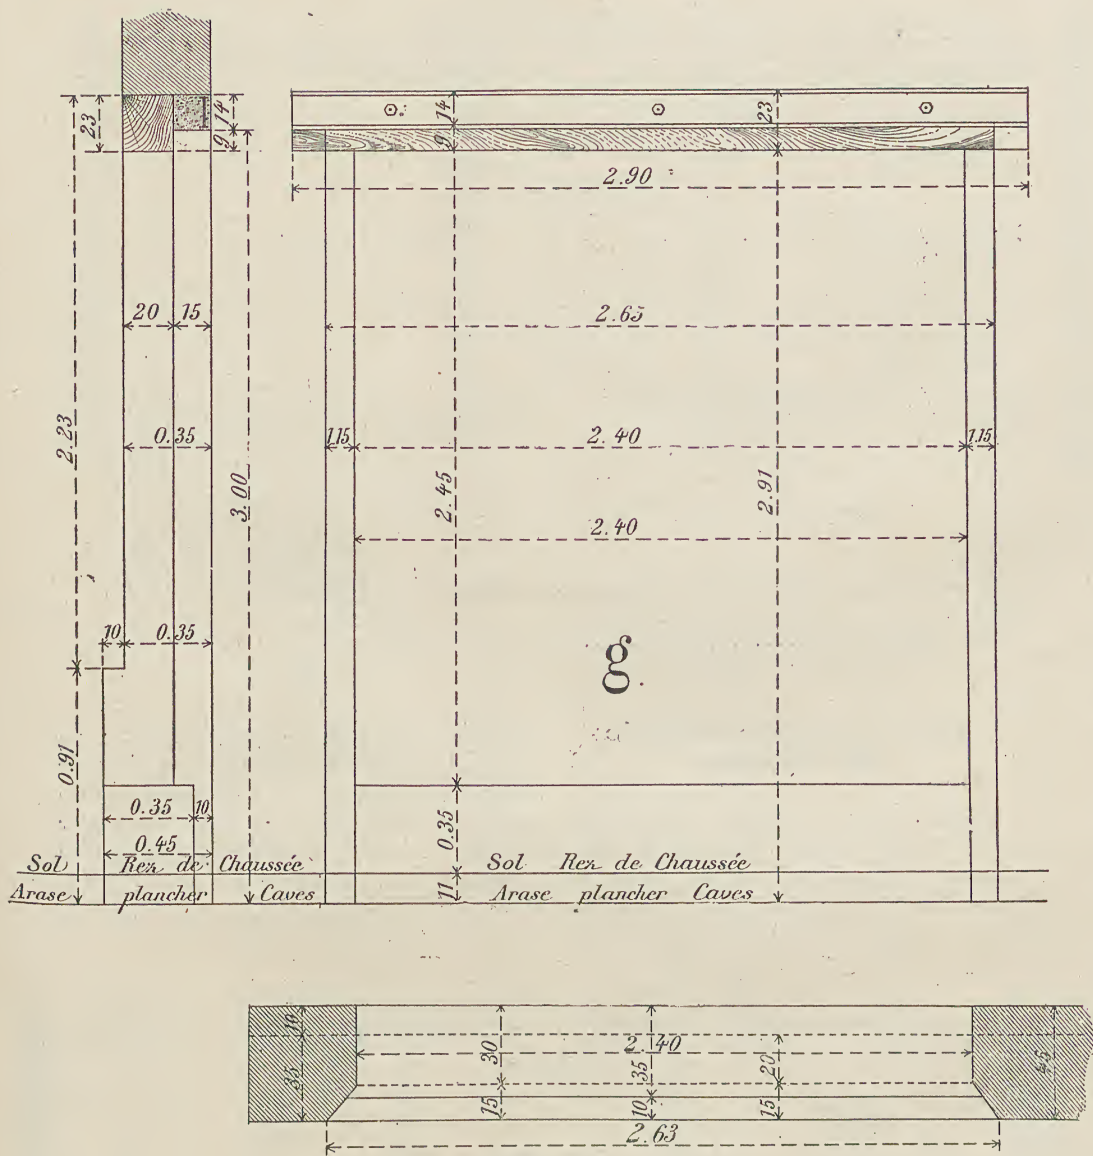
à 600. — Baie g. Coupe, élévation intérieure et plan.
